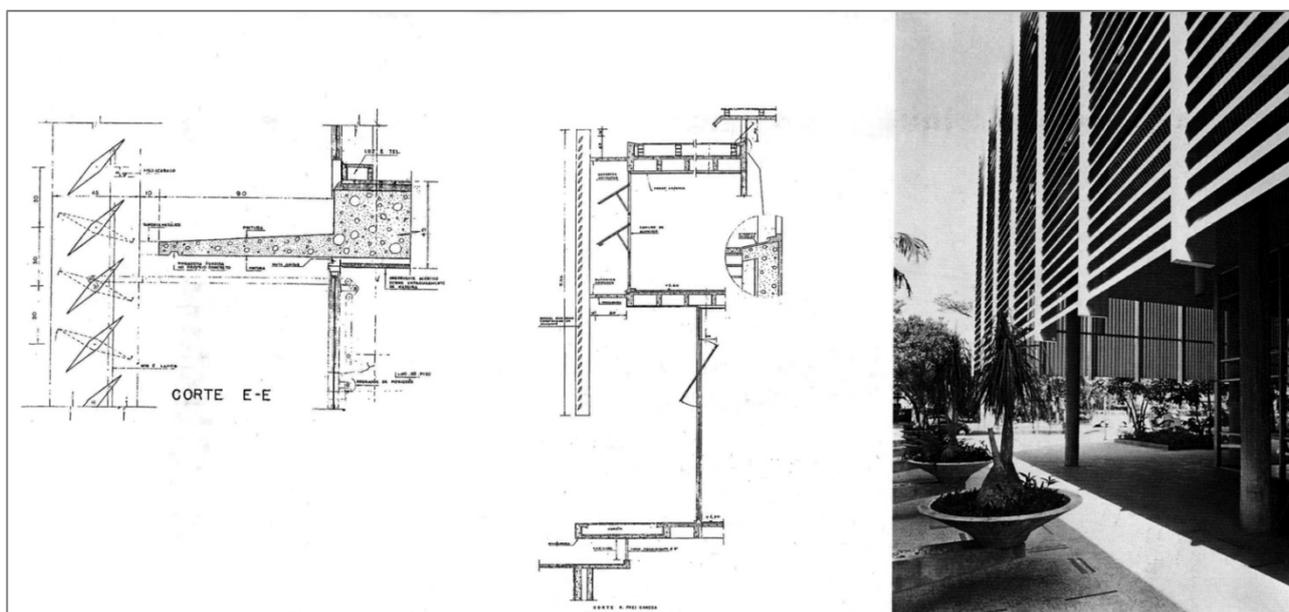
Detalhes construtivos dos brises e esquadrias do edifício base com foto de referência da planta baixa vista desde a entrada lateral para os escritórios olhando a Avenida Paulista.
